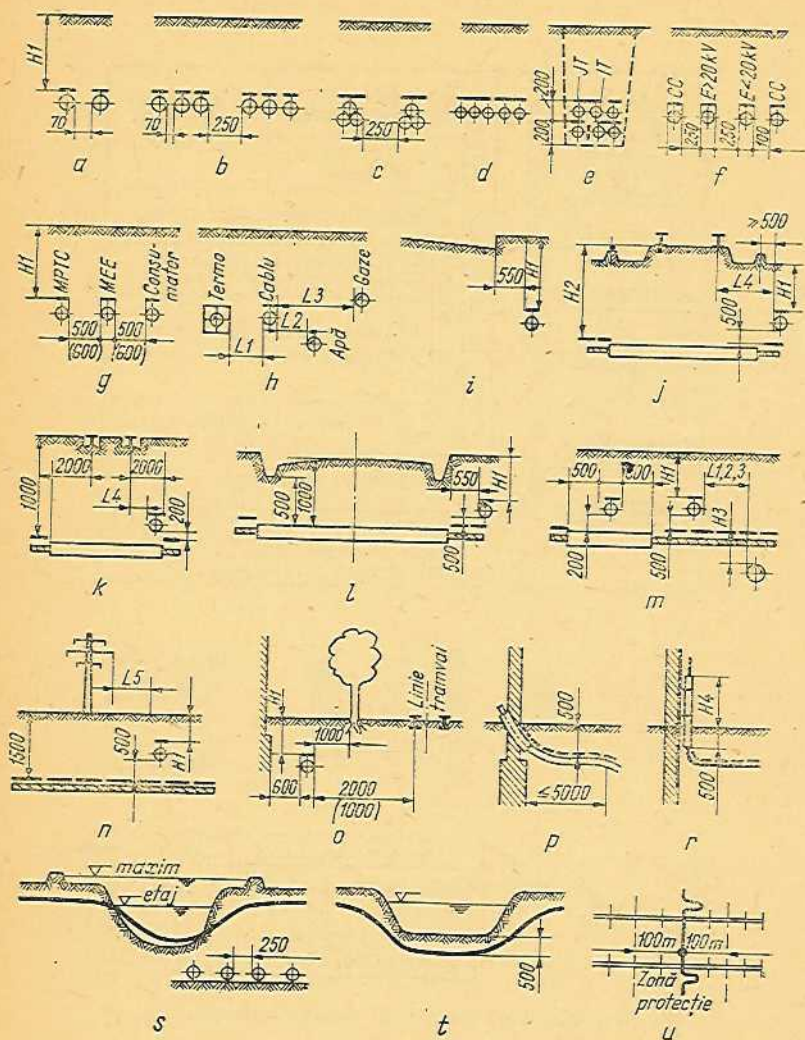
Distanțe minime la pozarea cablurilor în pământ.
